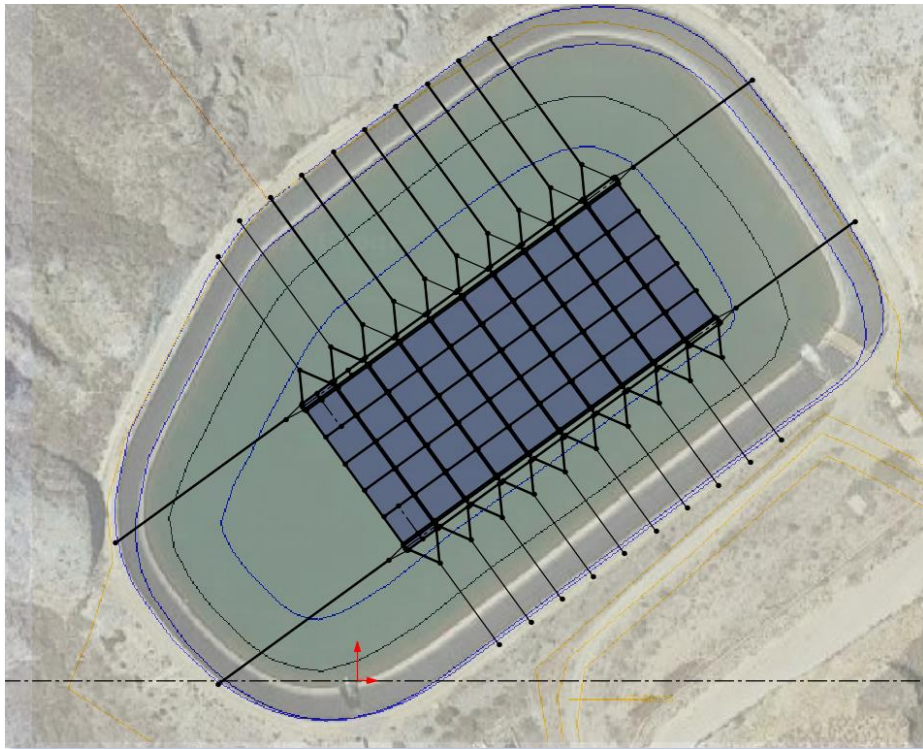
Vista en planta de la instalación fotovoltaica sobre la Balsa Abellán
